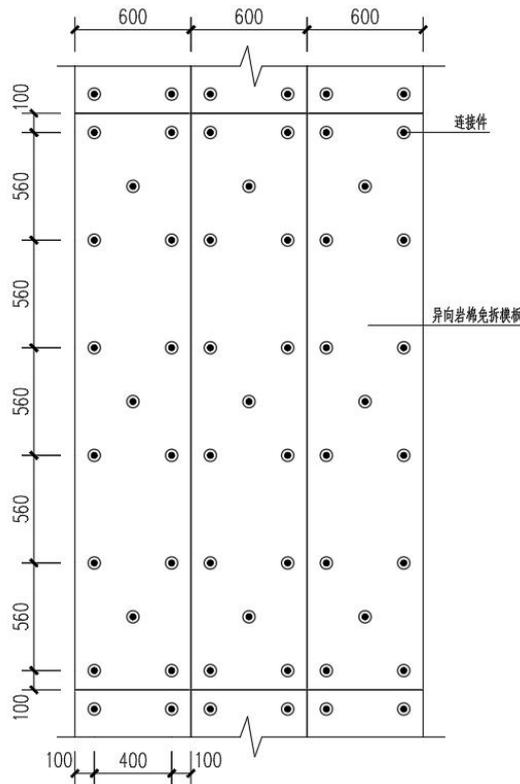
异向岩棉免拆模板连接件布置示意图
